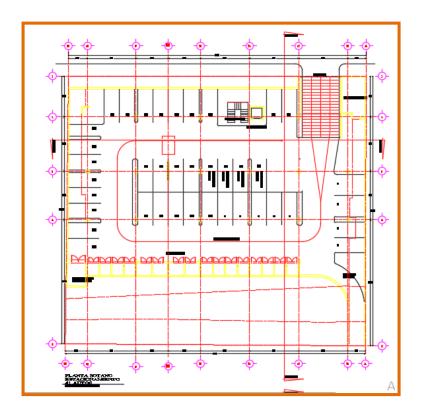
Planta Arquitectónica del Estacionamiento en Sótano.
